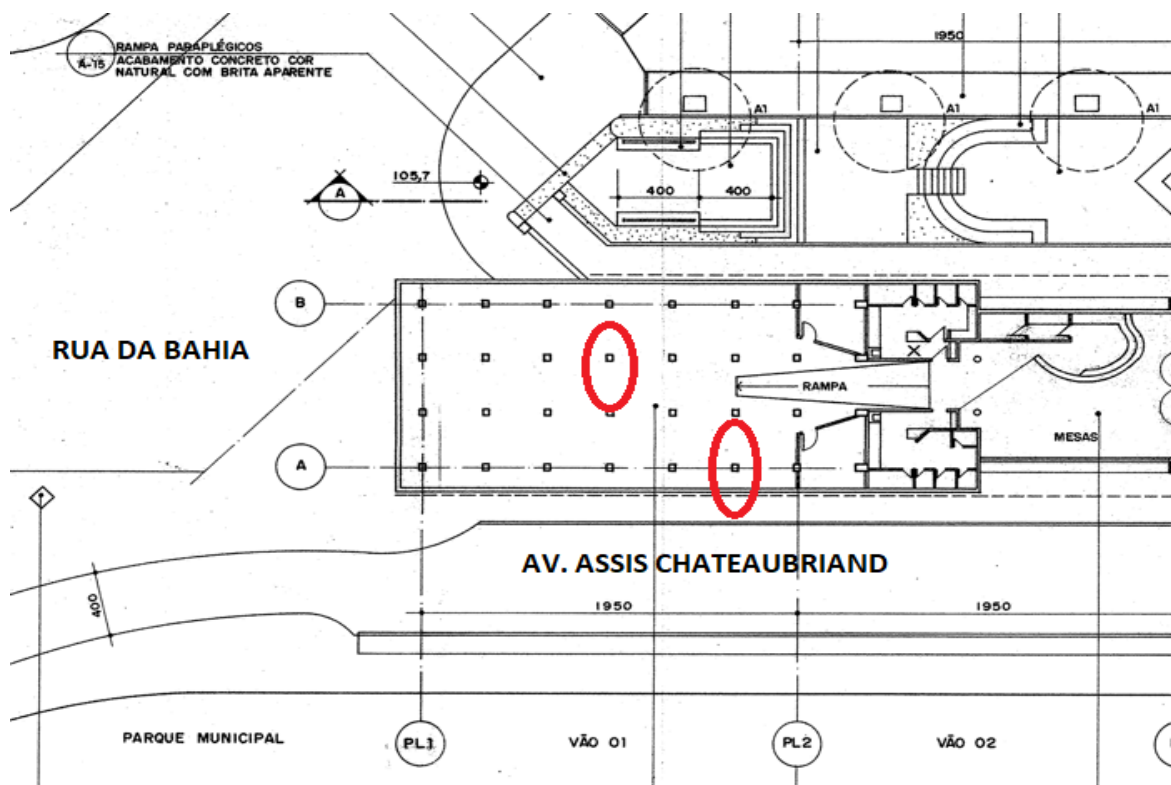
Planta de situação das manifestações patológicas de deslocamento e fogo, acesso em planta arquitetônica do viaduto Santa Tereza cedida pela Prefeitura de Belo Horizonte.
